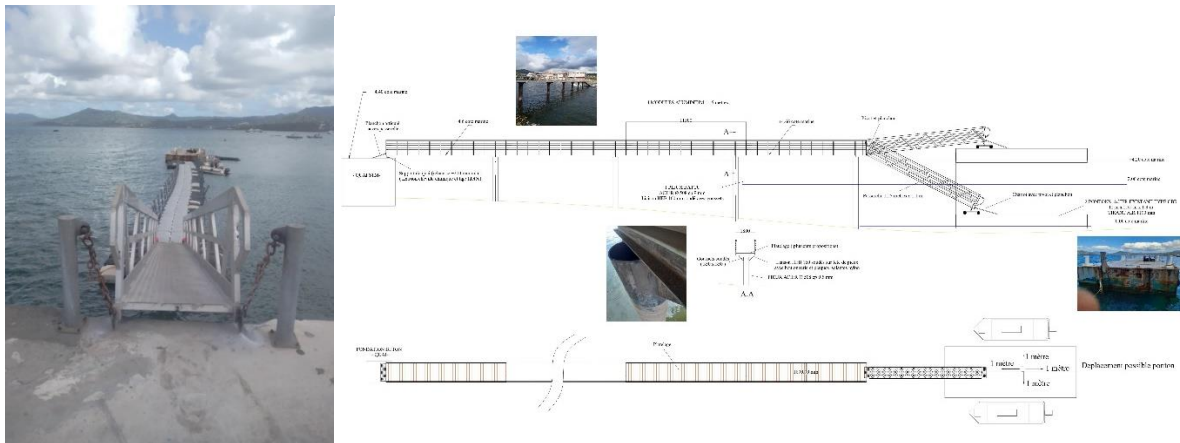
Ponton actuel et vue plan de l'ouvrage en projet
